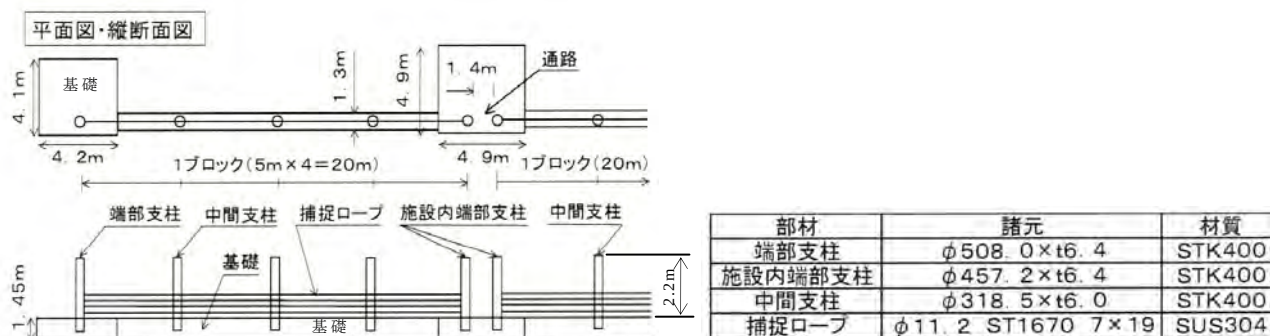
平面図・縦断面図および主な構造部材の諸元（文献 3-2 より引用）
